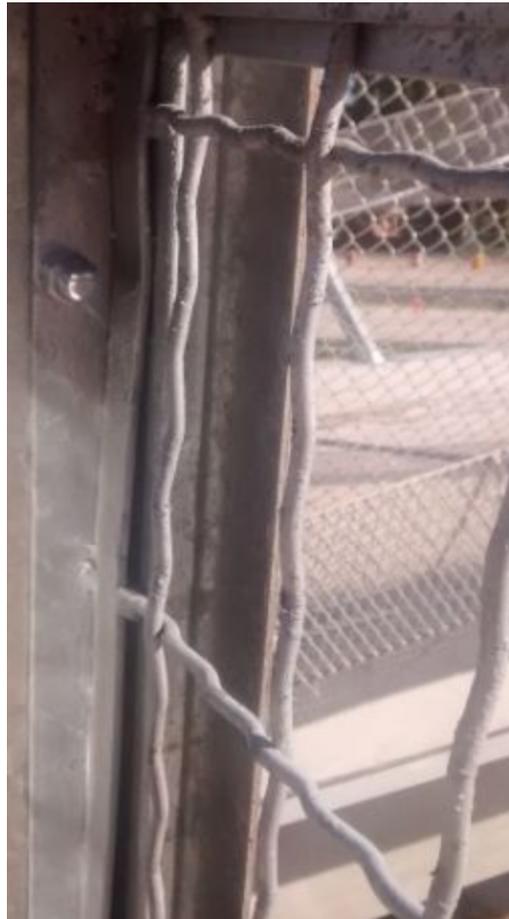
Bulones con punta soldada en el extremo.
